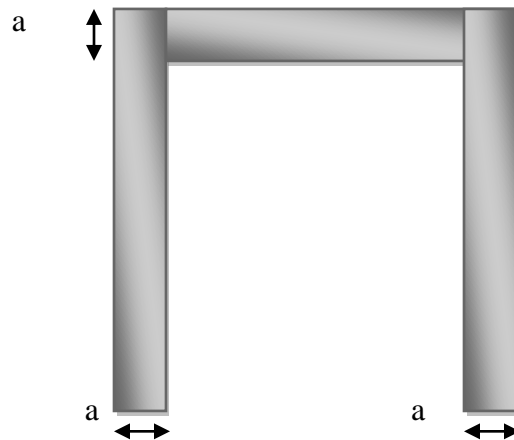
Vue en plan du voile de la cage d'ascenseur
